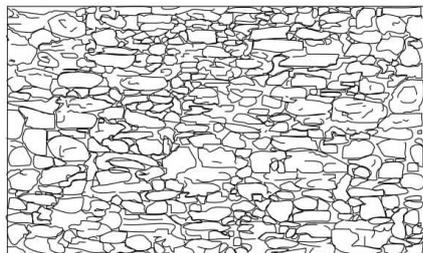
Abaco delle murature irregolari, sezione 3.1A.
